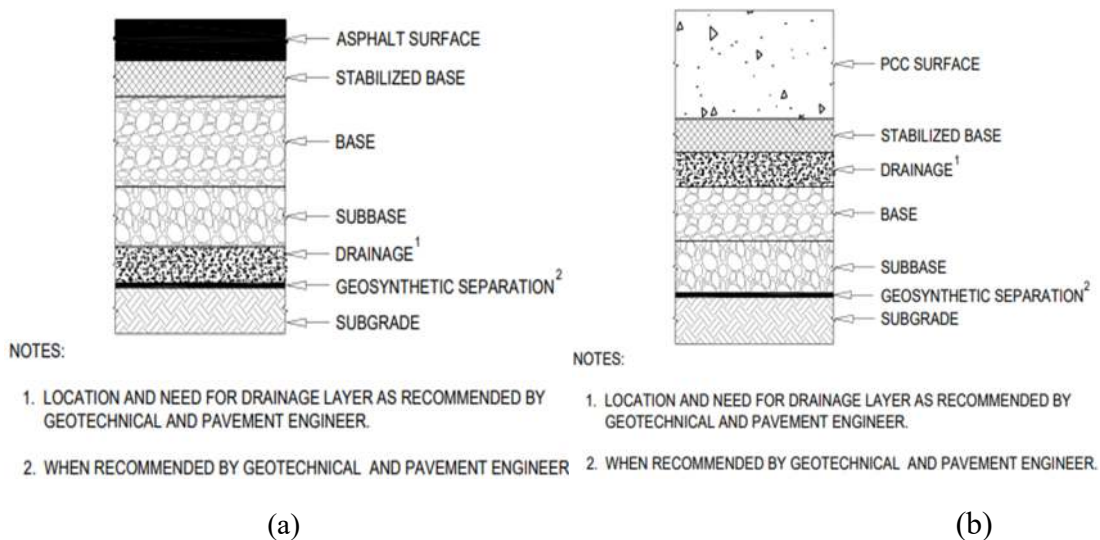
(a) Estructura típica del pavimento flexible (b) Estructura típica del pavimento rígido
